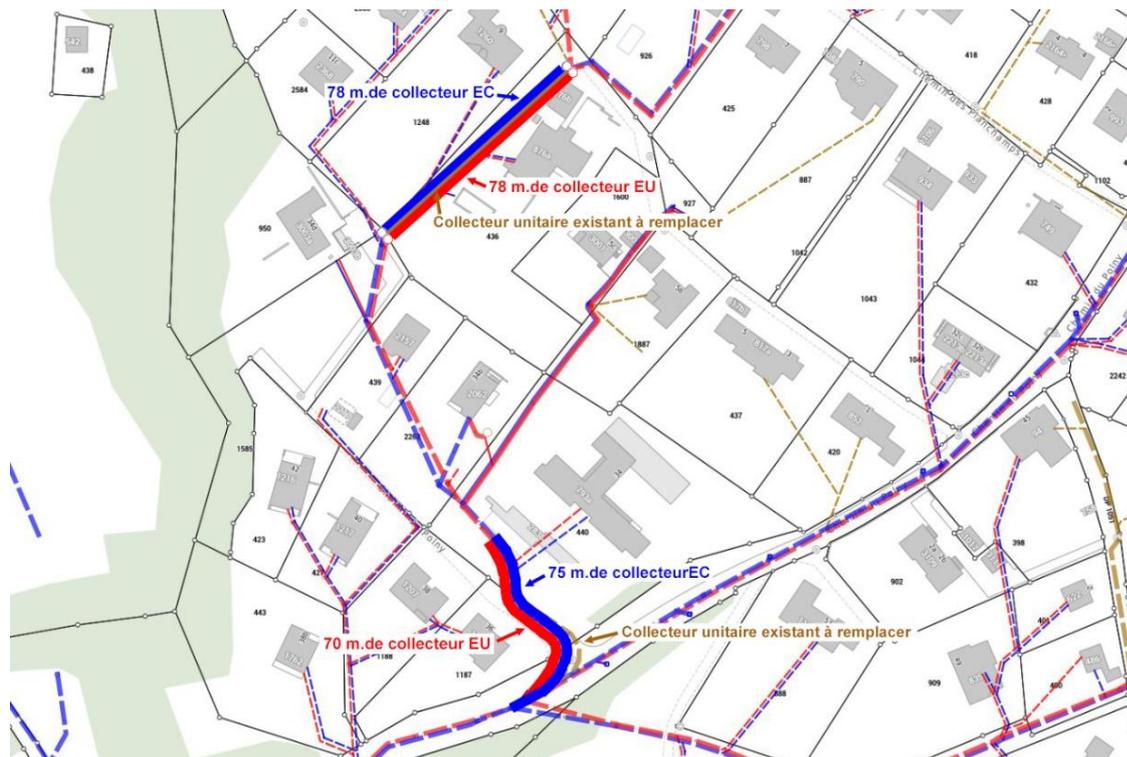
Plan des collecteurs du secteur de Crausaz / Polny
